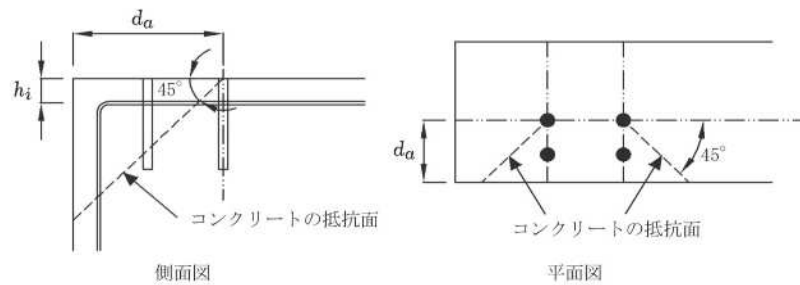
コンクリートの抵抗面積  $A_c$  (道示IV図-解 7.6.3、7.6.4)
